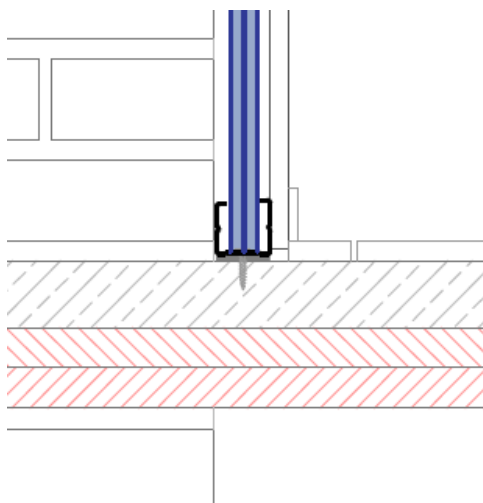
detalle trasdosado de fachada principal con láminas de aerogel. Autora. Fuente: Garay y Uriarte. 2016.
